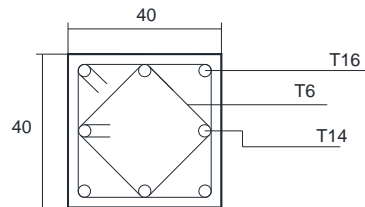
Ferrailage d'un poteau 40x40cm (poutres normales - bâtiment R+10)
